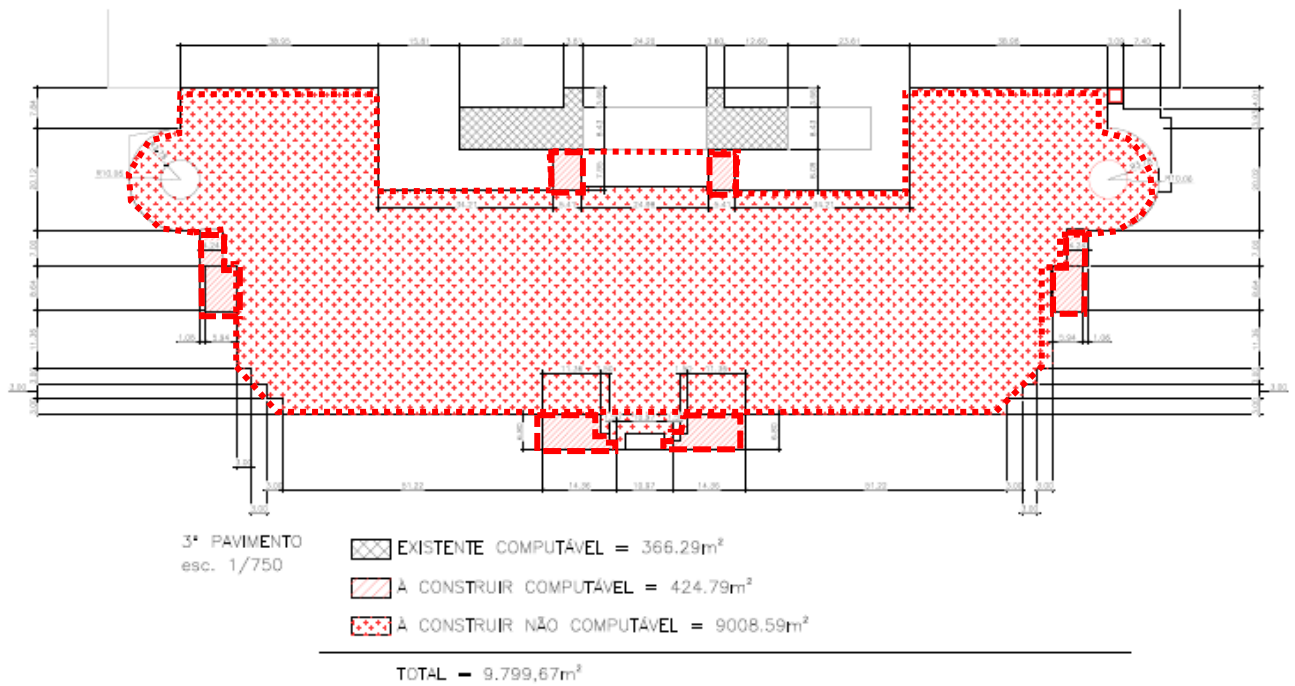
Terceiro pavimento. Fonte: Engexpor.
